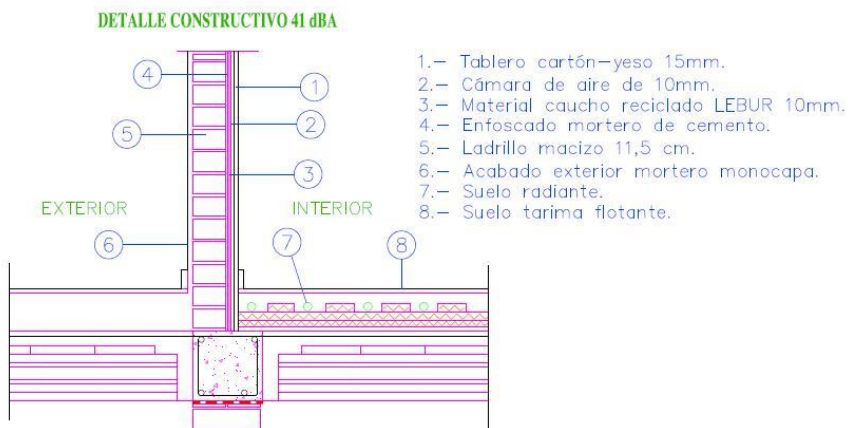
Detalle constructivo de fachada con aislamiento de LEBUR. Elaboración propia. 2015
